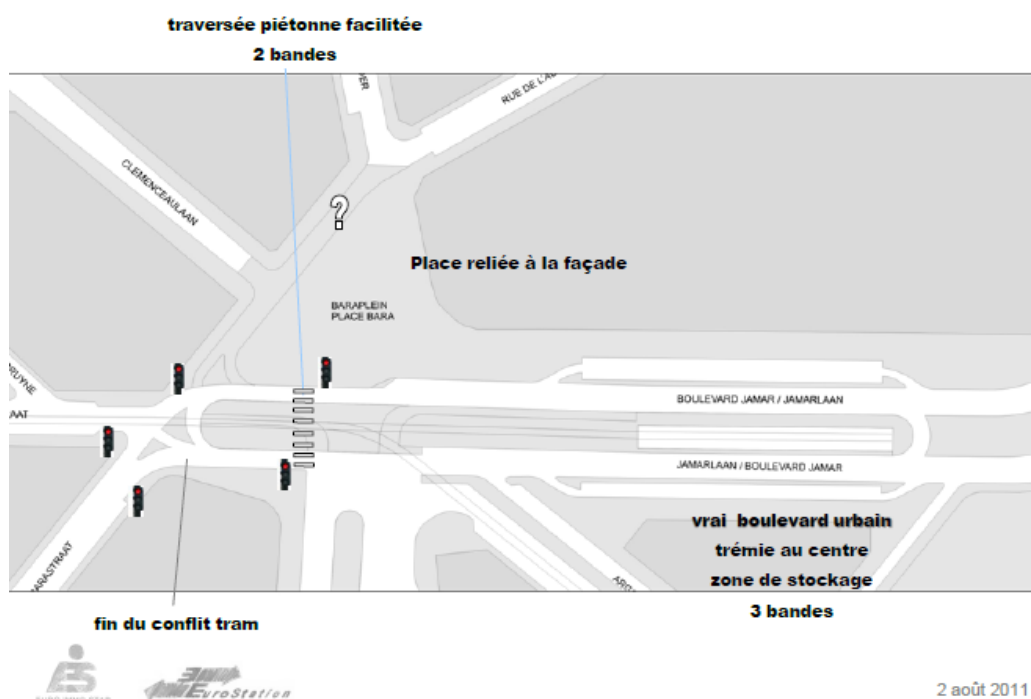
Proposition de réaménagement de la place Bara – détails des propositions
